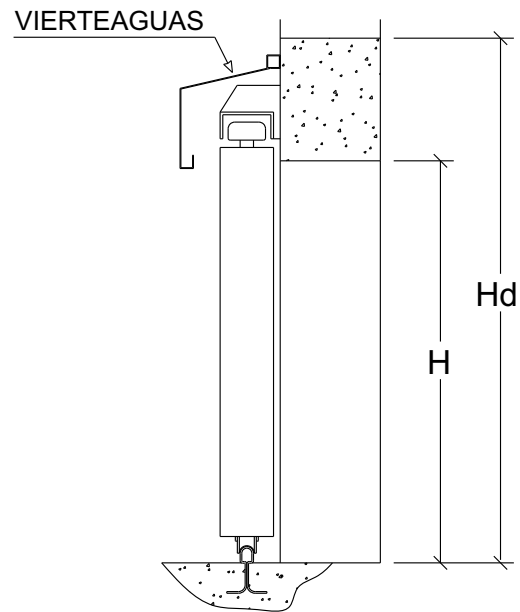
Detalle de sección vertical de puerta industrial corredera apoyada
